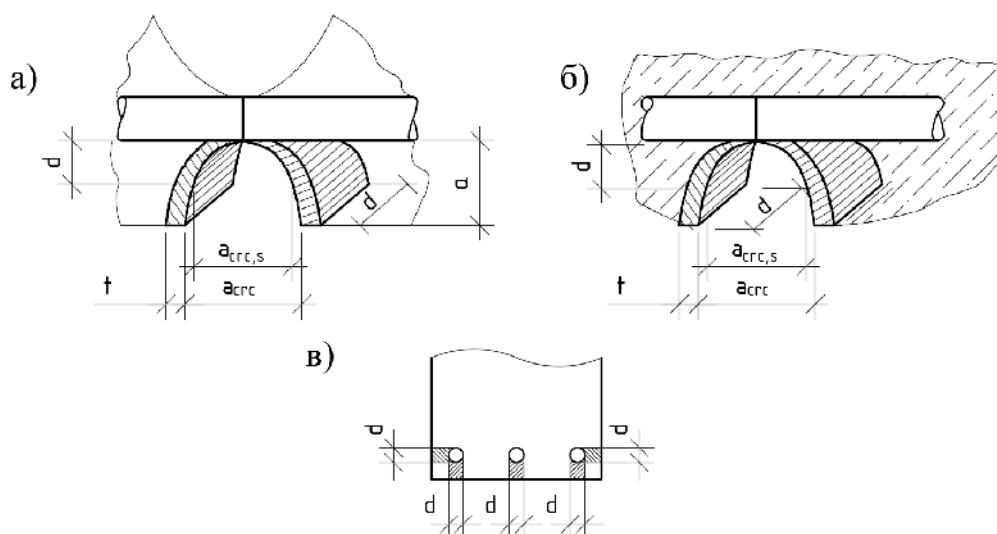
Расчетные схемы полосок-консоль, вырезанных в окрестностях боковых или нижней граней железобетонной конструкции: *а* – вид сбоку; *б* – вид сверху; *в* – расположение вырезанных полосок в поперечном сечении
